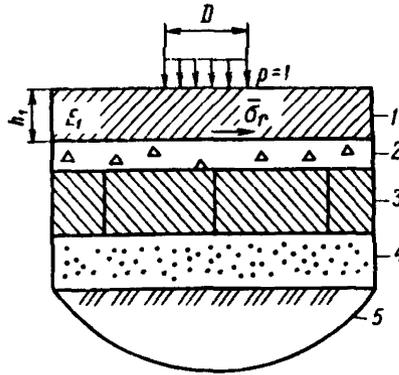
Расчетная схема для определения растягивающих напряжений в асфальтобетонном покрытии, расположенном на блочном основании с трещинопрерывающими слоями: 1-асфальтобетонное покрытие толщиной h_1 , 2-трещинопрерывающий слой; 3-блочное основание; 4-нижние слои основания; 5-грунт земляного полотна; D -диаметр круга, равновеликого площади контакта колеса с покрытием; $\bar{\sigma}_r$ -растягивающее напряжение в асфальтобетонном покрытии от единичной нагрузки $p = 1$
